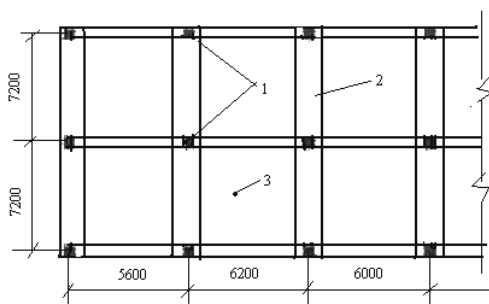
Схема надстройки зданий с использованием каркаса с преднапряженными плоскими ригелями
